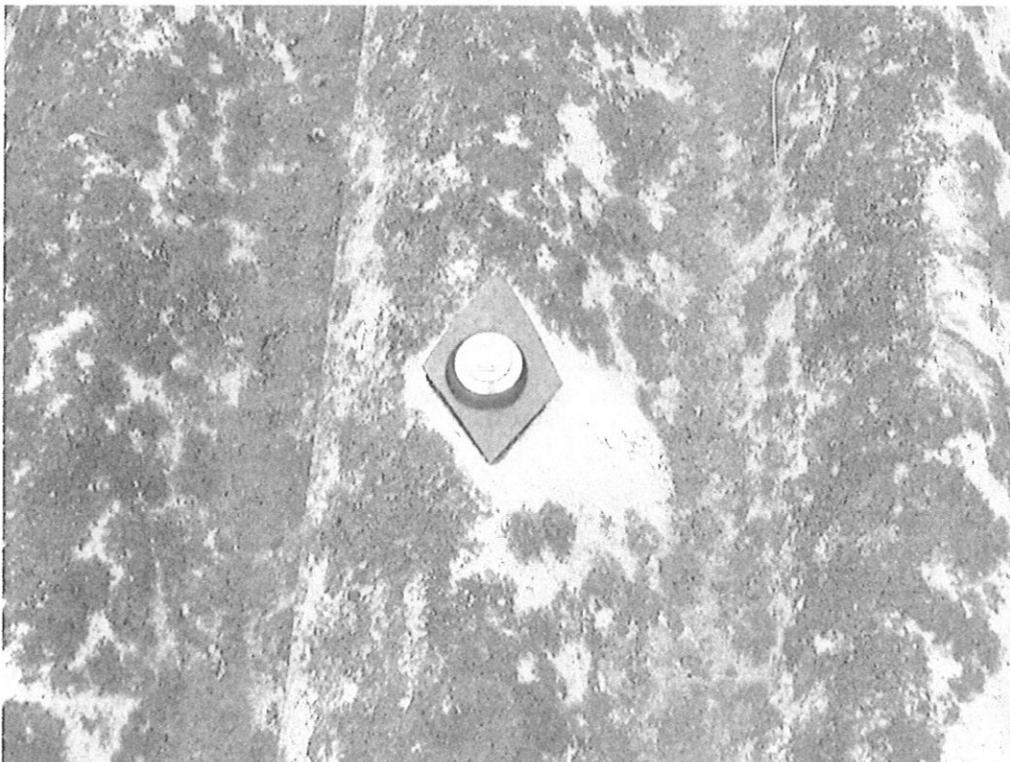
zona E - particolare della superficie delle lastre e del fissaggio
